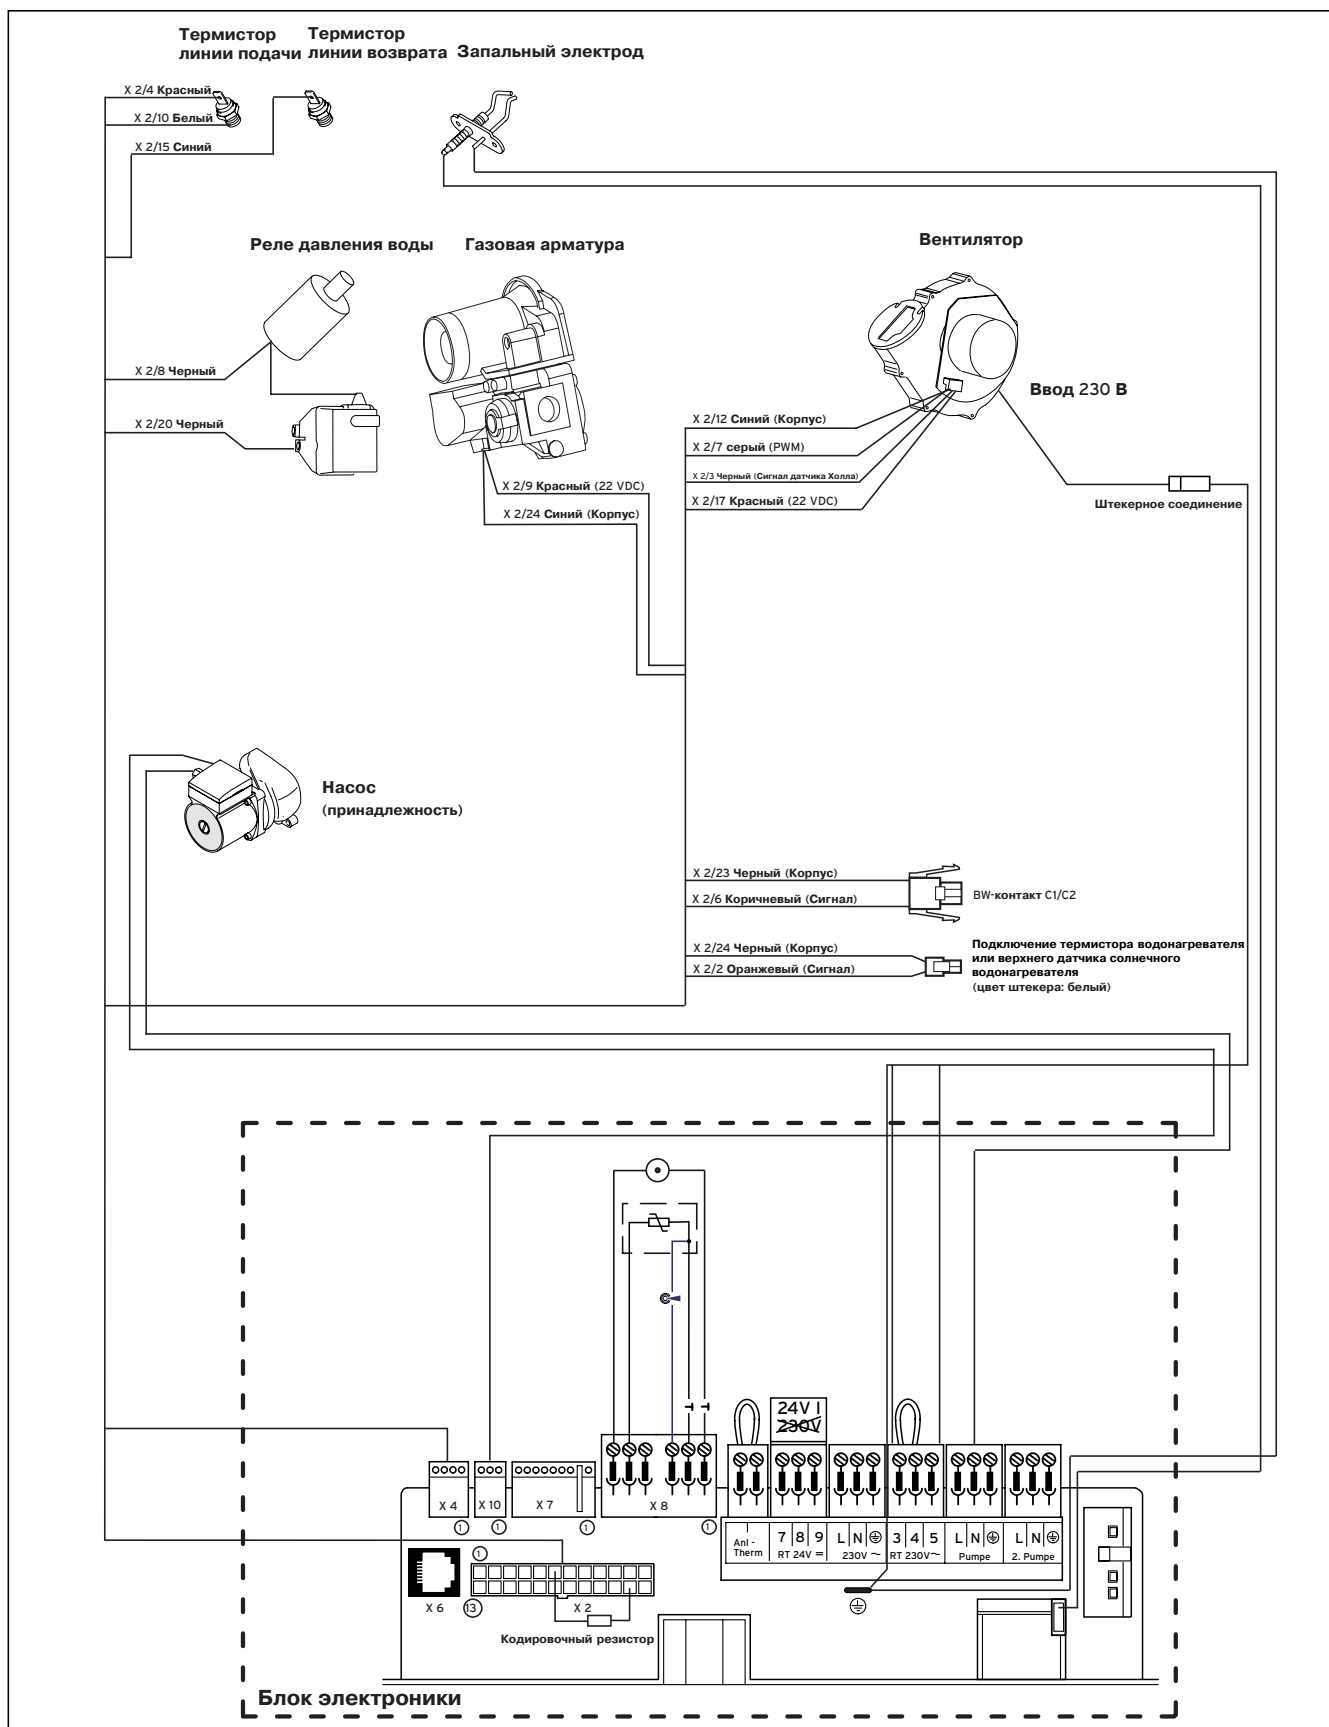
Схема проводного монтажа esotec VU 656-7
